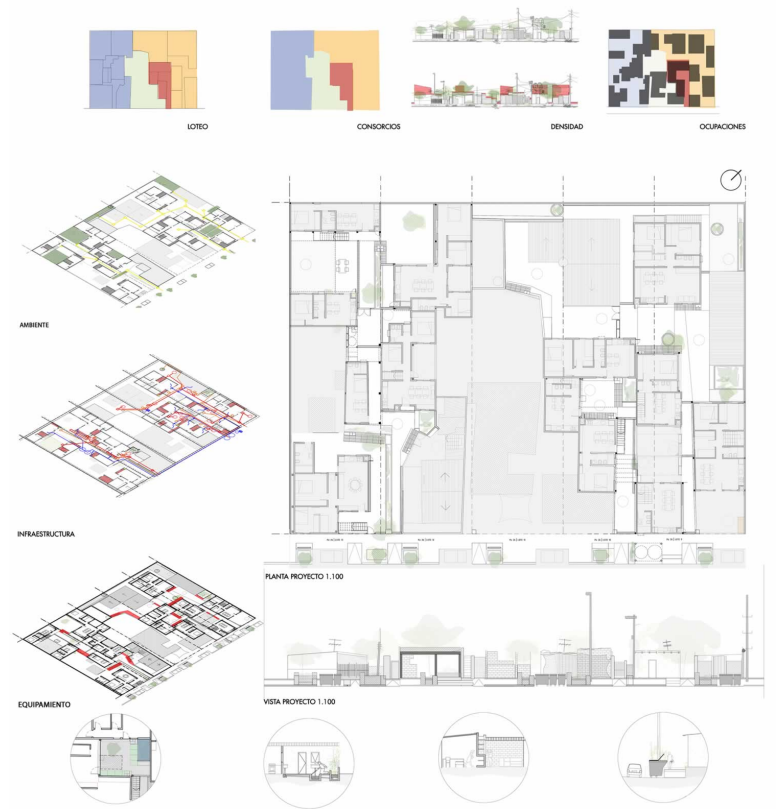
Barrio San José. Proyecto Planta 1er nivel
